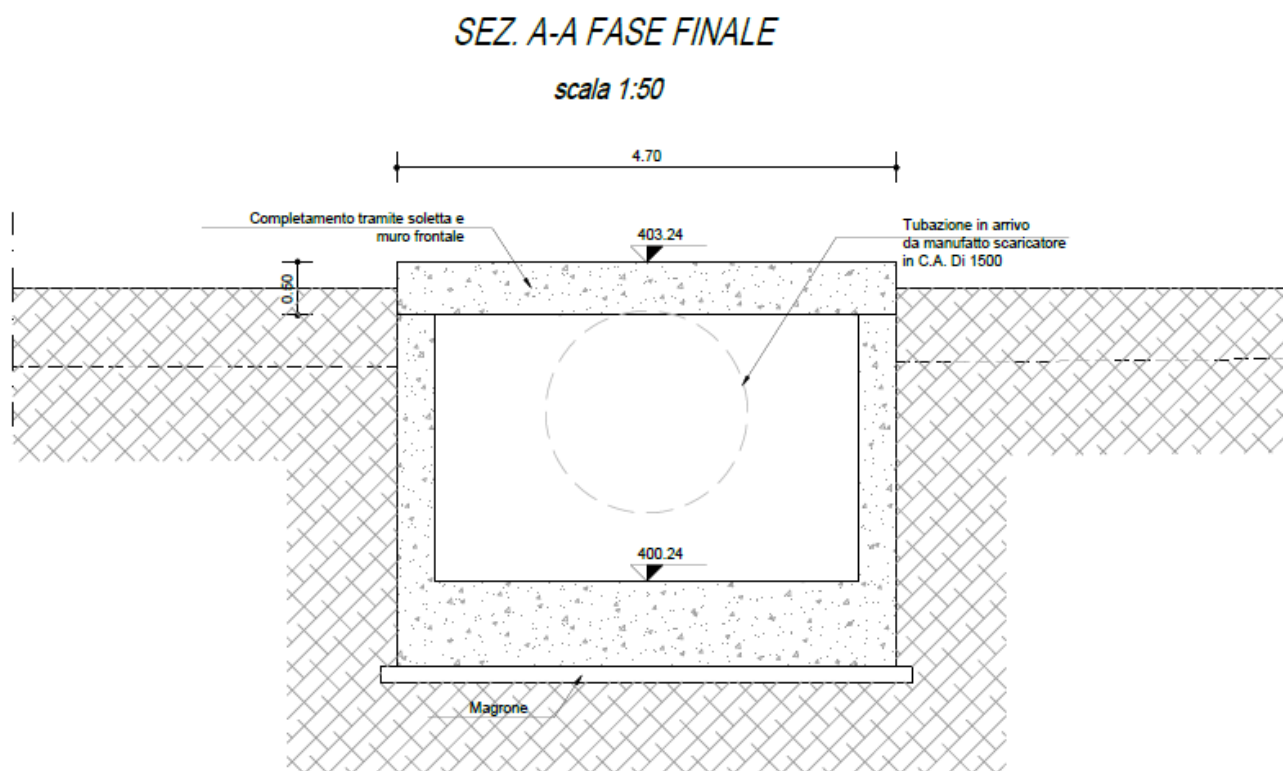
Sezione trasversale del pozzetto spingitubo in fase finale
